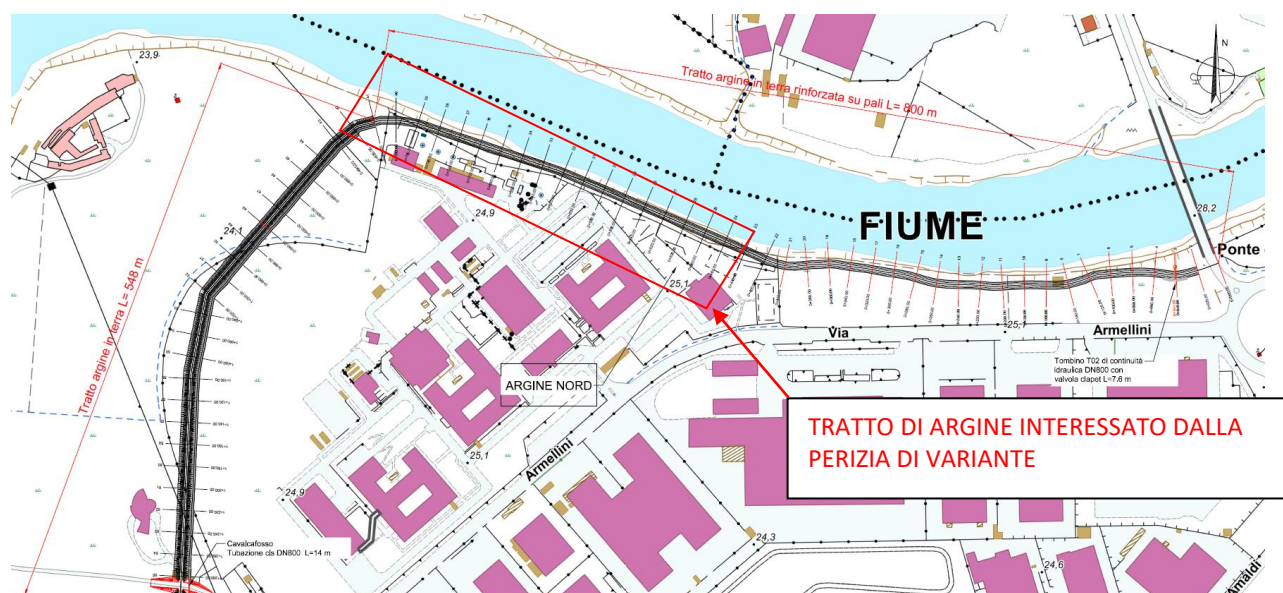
Estratto planimetrico di progetto con individuazione del tratto interessato dalla perizia di variante
